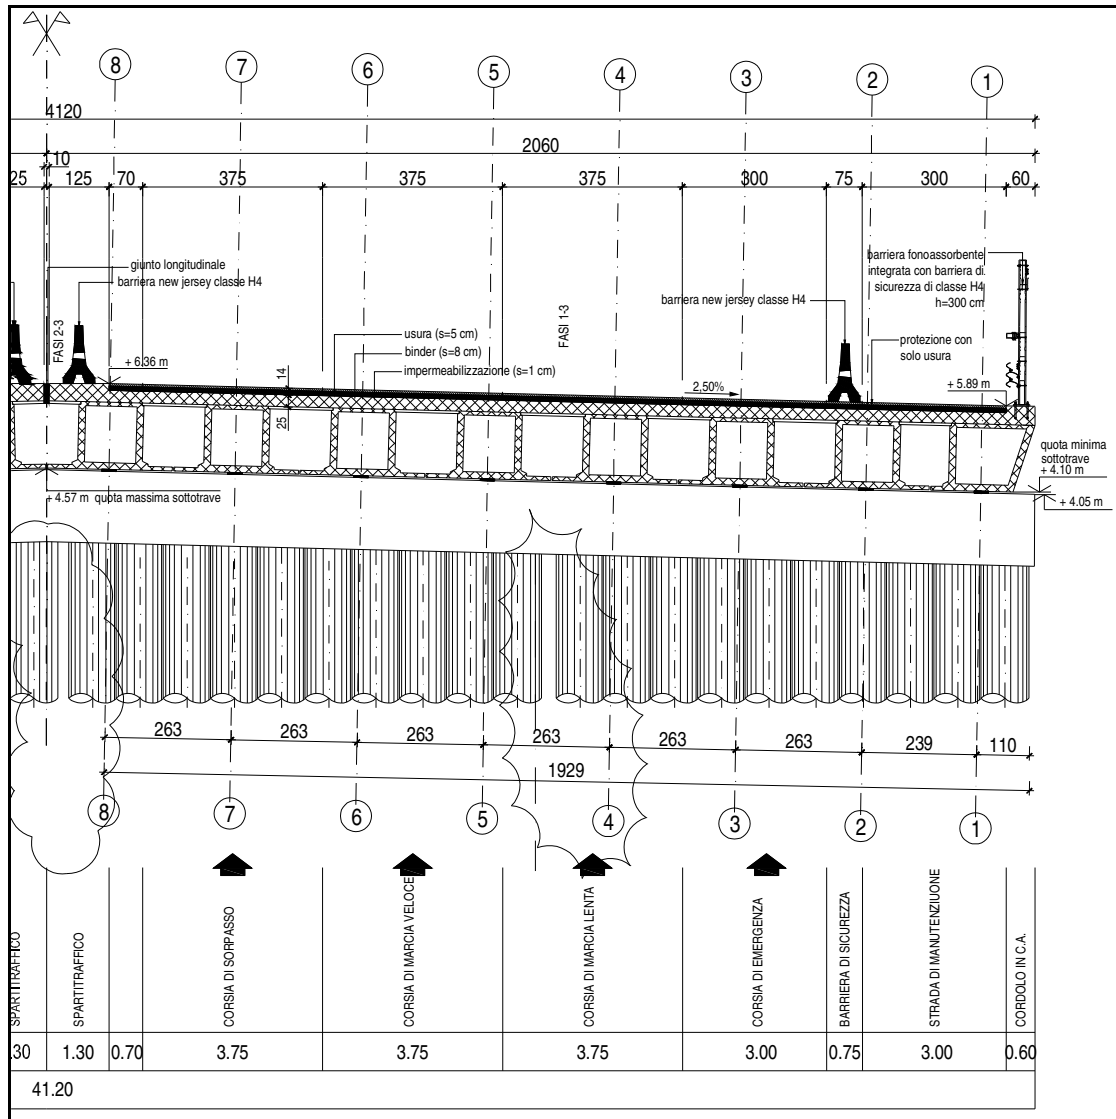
Sezione trasversale tipica dei ponti oggetto dello studio
